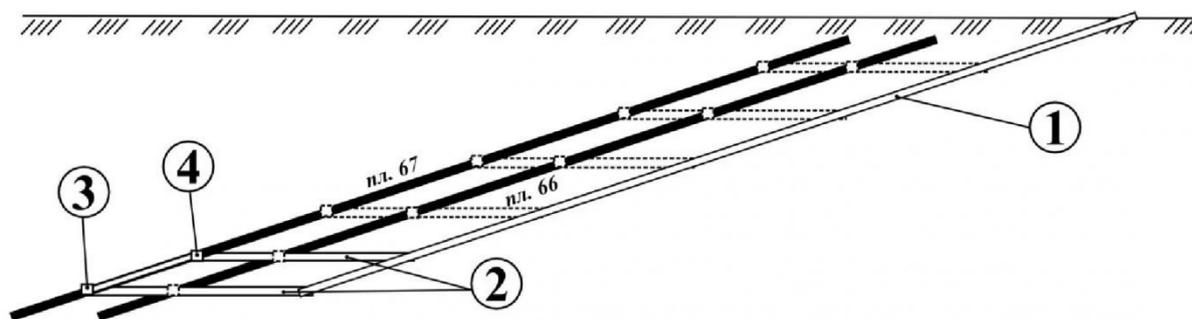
Схема вскрытия наклонными стволами, проводимыми по породам: 1 - наклонные стволы (вентиляционный, конвейерный, путевой); 2 - этажные квершлагы (вентиляционный и конвейерный); 3 - этажные штреки.
